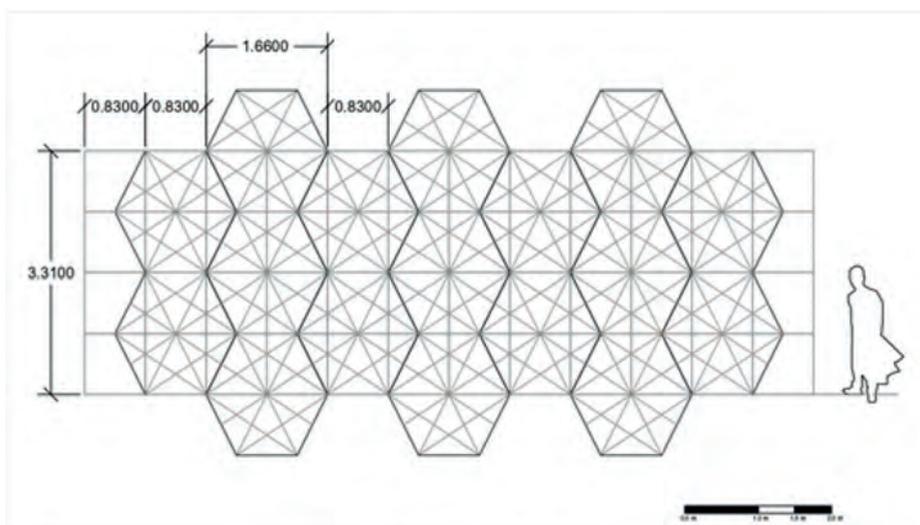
Diseño de teselación en una planta - Vista en elevación. Fuente: Elaboración Propia
